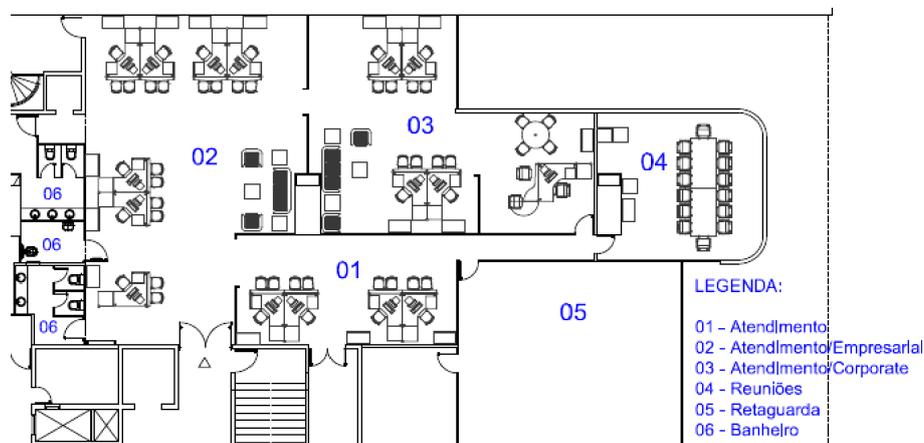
Planta do primeiro pavimento da antiga agência BNB Fortaleza-Centro (CE).
